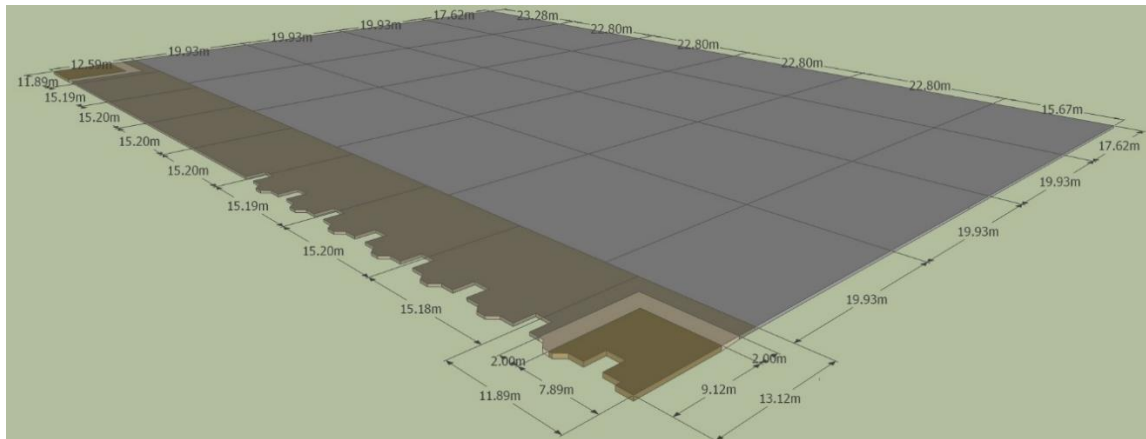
PLANTA DE CONJUNTO CEDIS-CDN PRIMER ETAPA.
